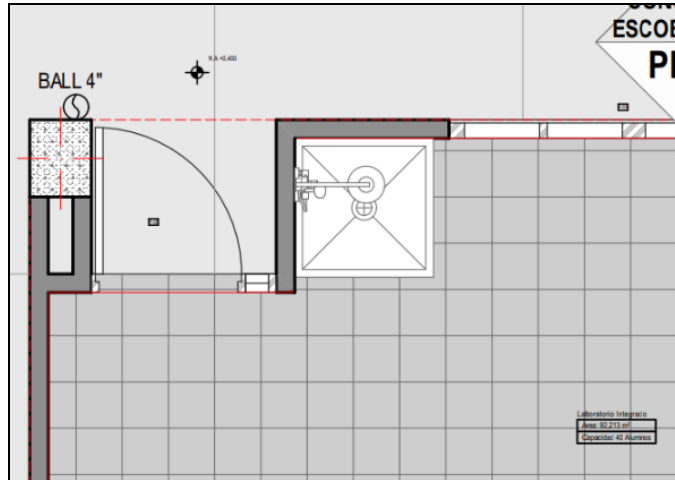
Detalle zona lavaojos – Laboratorio I.E. Antonio Nariño sede principal – Plano Planta Bloque Laboratorio - Centro de Recursos, Planta Detalle B. Laboratorio y Centro de Recursos, Corte B-B B. Laboratorio-Centro R. Detalle de Piso 2., Localización detalles Pisos Plano No. A-701
